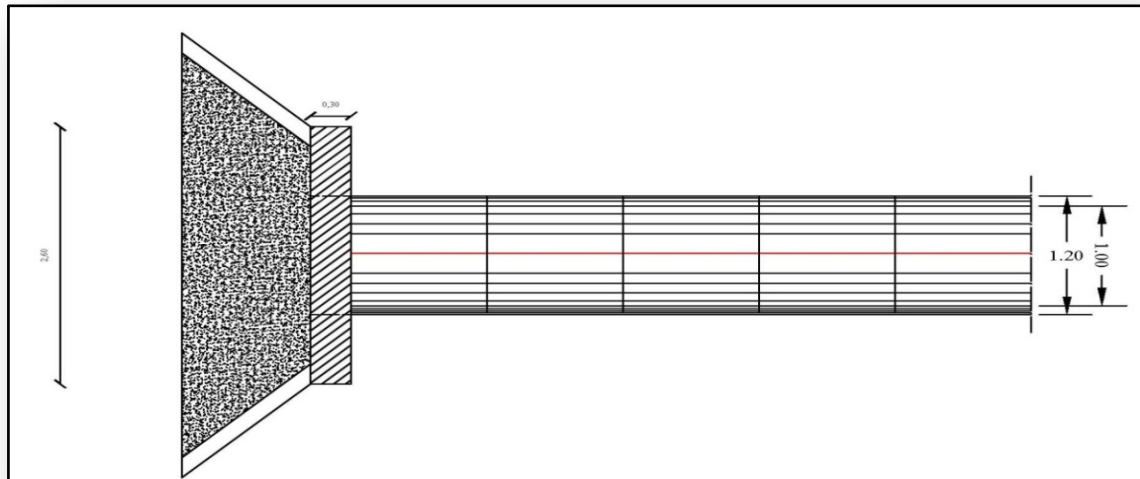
Vue en plan de l'ouvrage.
